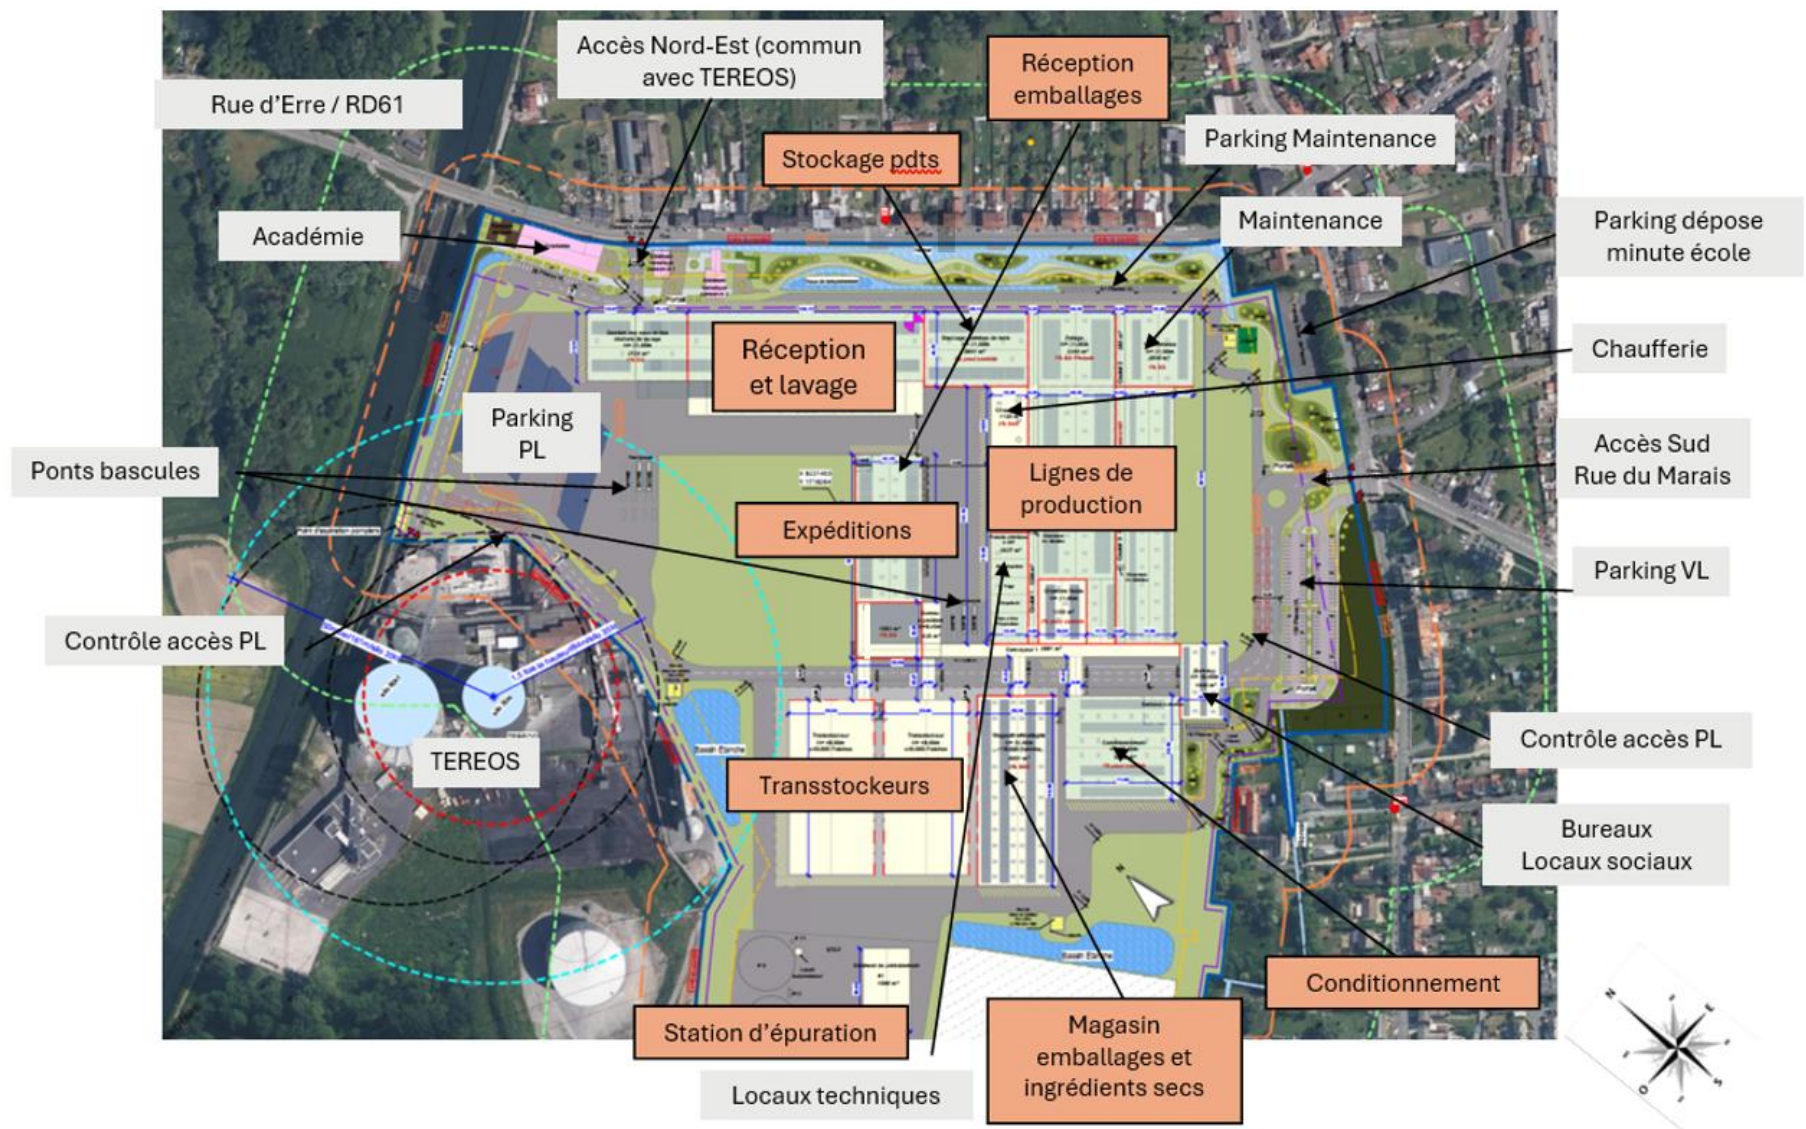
Plan des installations relevant du périmètre IED du rapport de base- en rouge sur le plan
